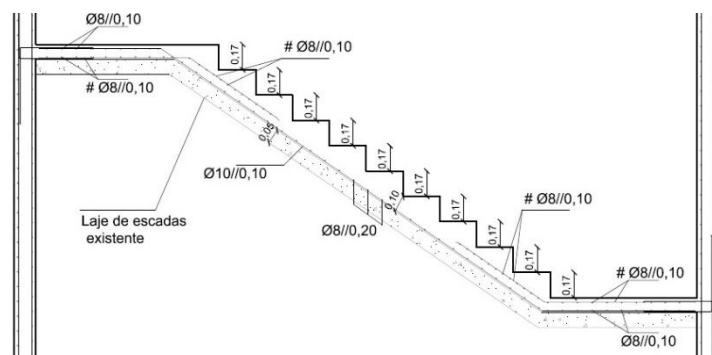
Detalhe da armadura das escadas centrais do piso 1 ao piso 7
